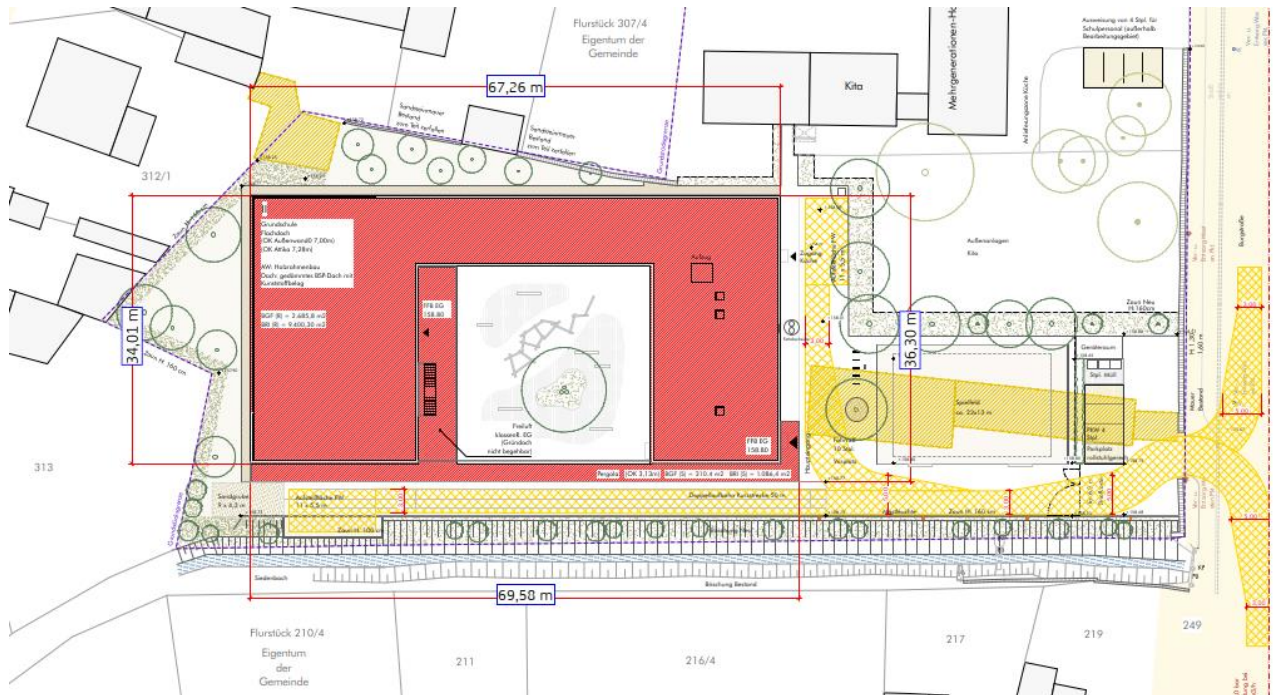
Ausschnitt aus dem /Lageplan/ mit Darstellung der Abmessungen
